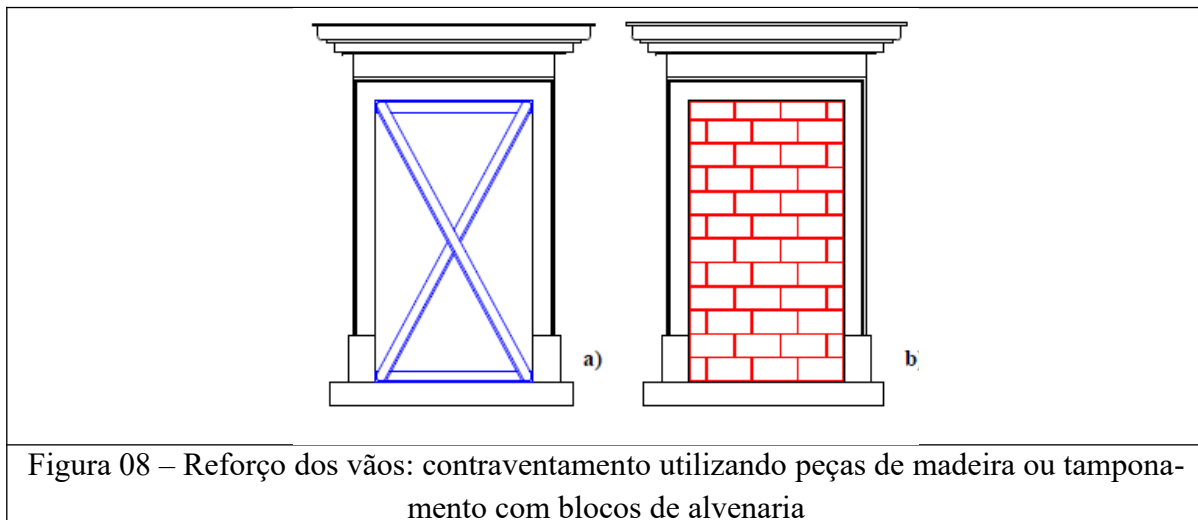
Reforço dos vãos: contraventamento utilizando peças de madeira ou tamponamento com blocos de alvenaria
